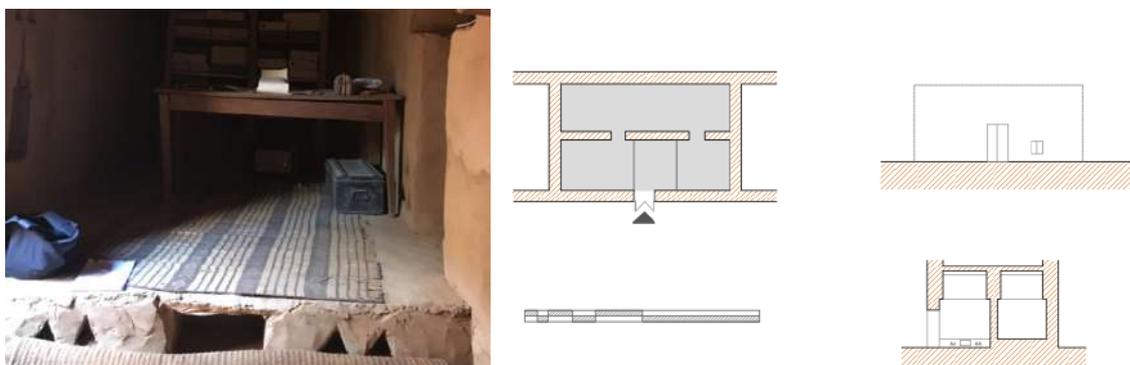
Interior da Biblioteca Ahel Loudaa e o seu levantamento arquitetónico. (Terrachidia, 2020)
